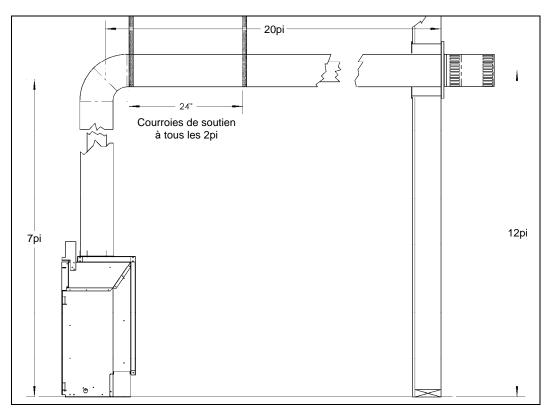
Configuration d'évacuation illustrant un maximum de 20pi de conduit horizontal avec conduit vertical de 7pi.
